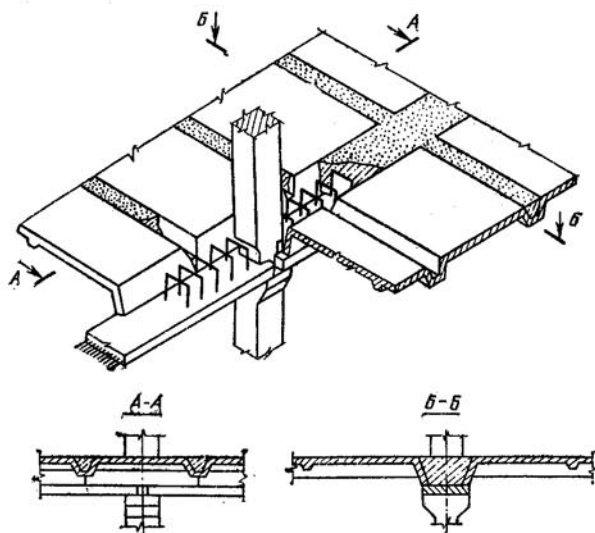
Ребристые сборно-монолитные перекрытия с остовом из железобетонных панелей
